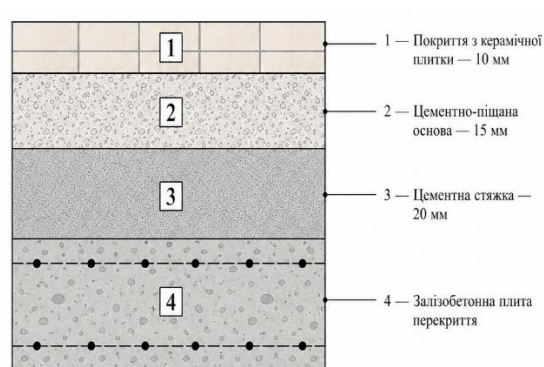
Конструкція підлоги міжповерхових поверхів, тип 3
